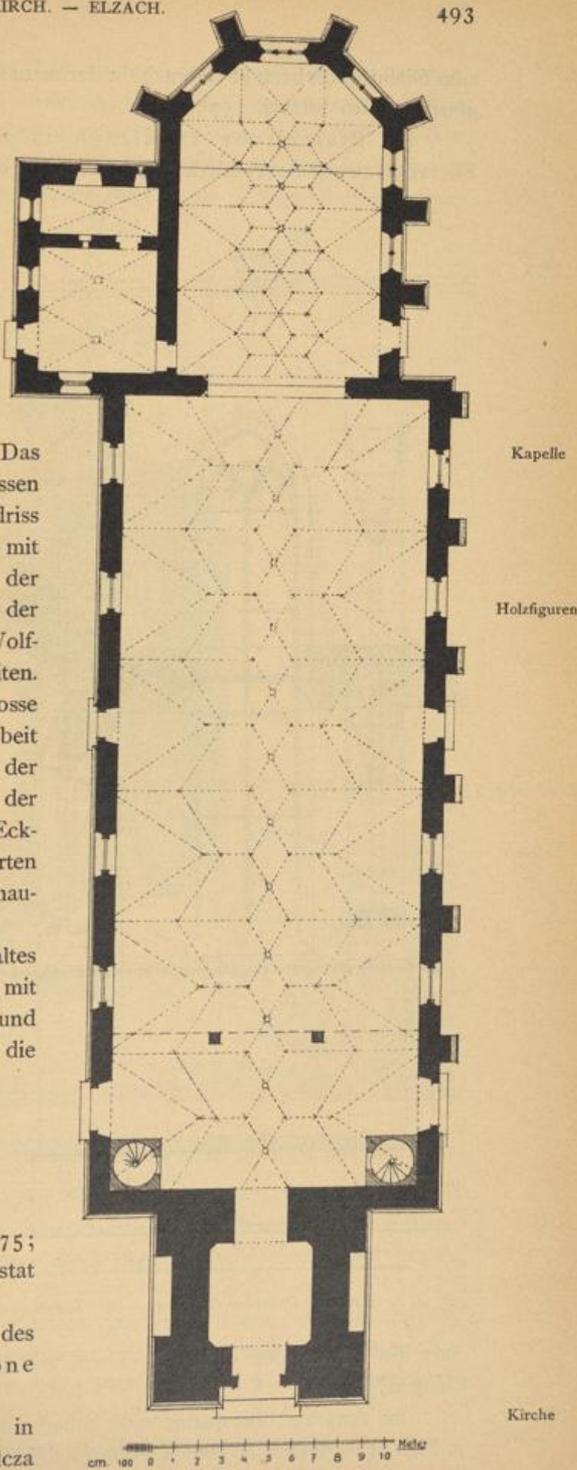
Elzach. Pfarrkirche, Grundriss.
